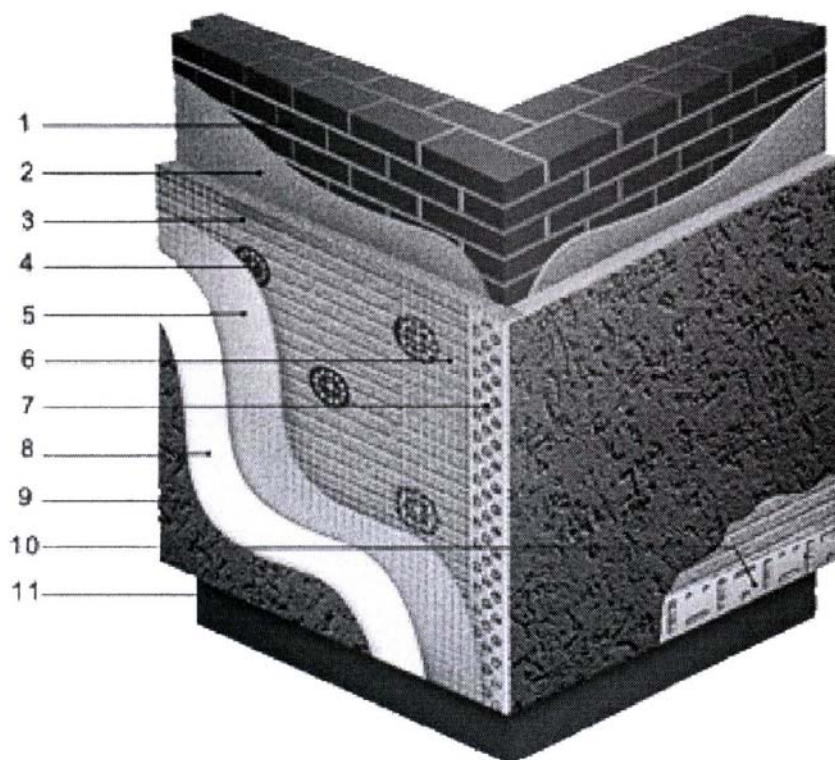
Способ дополнительного утепления стен с использованием армированной штукатурки:
